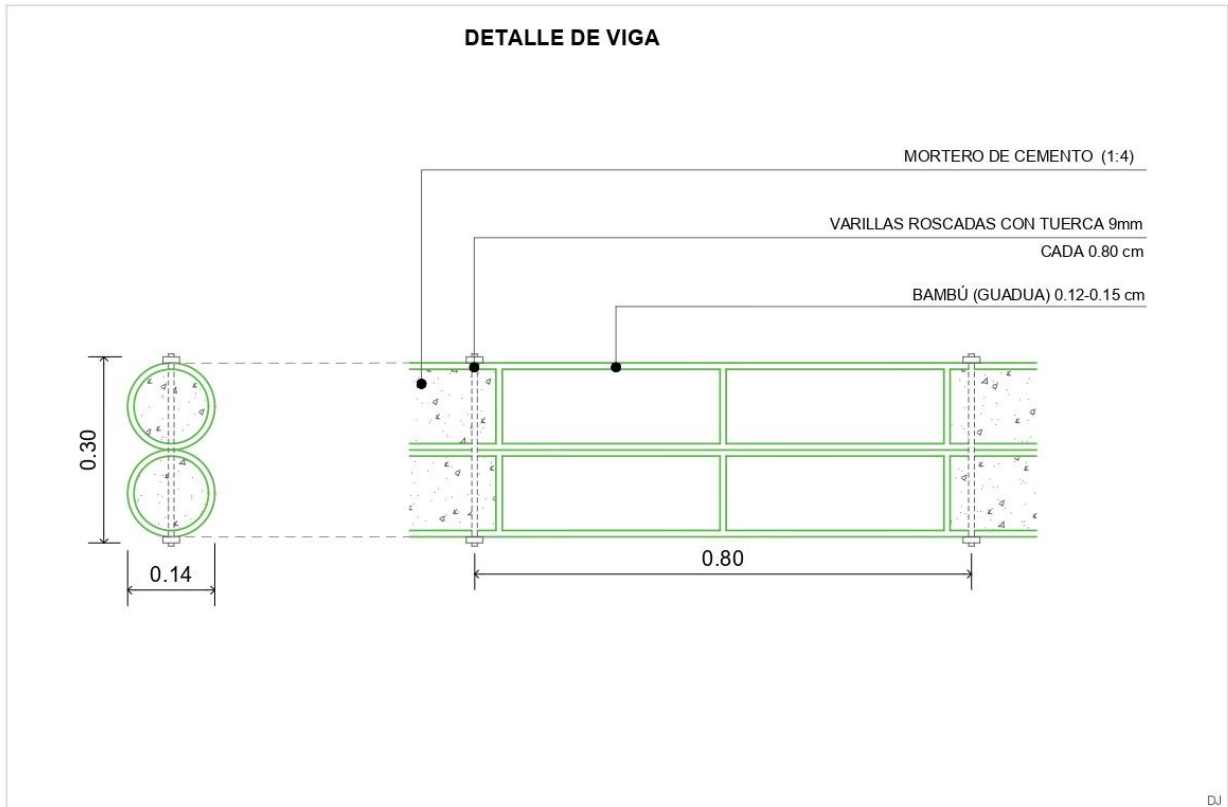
Detalle constructivo de viga compuesta. Fuente: El autor
